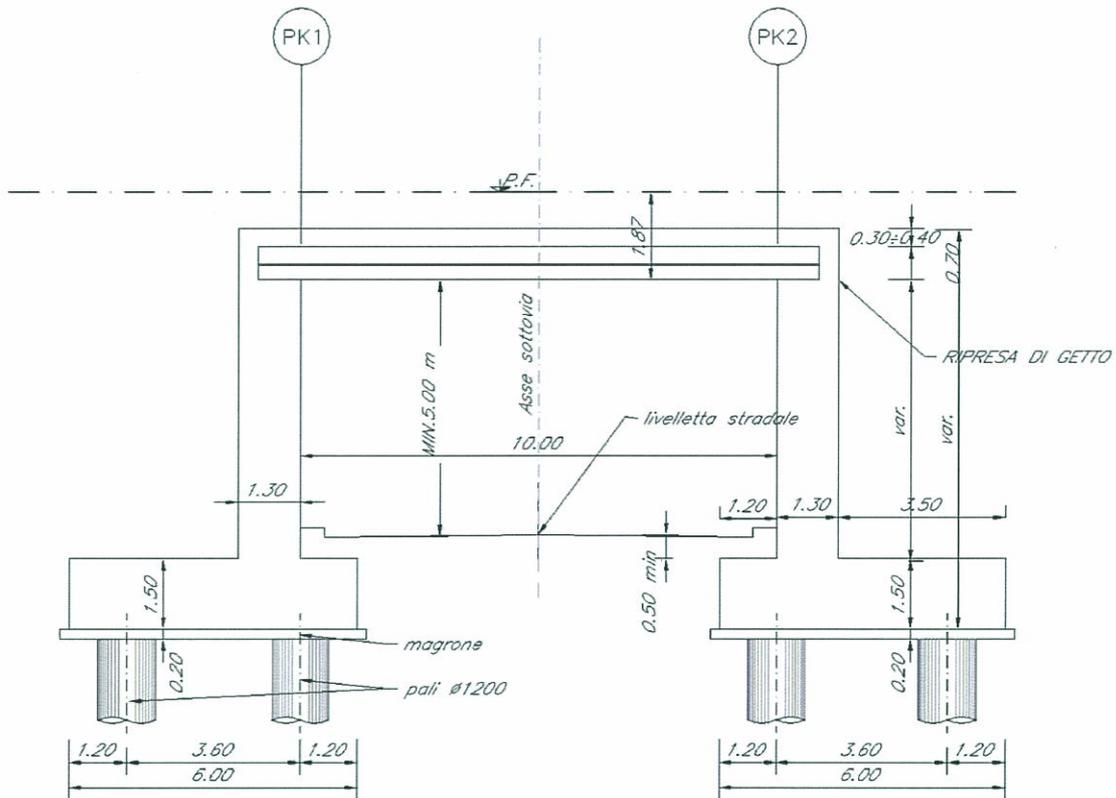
Prospetto in corrispondenza di attraversamento stradale.
